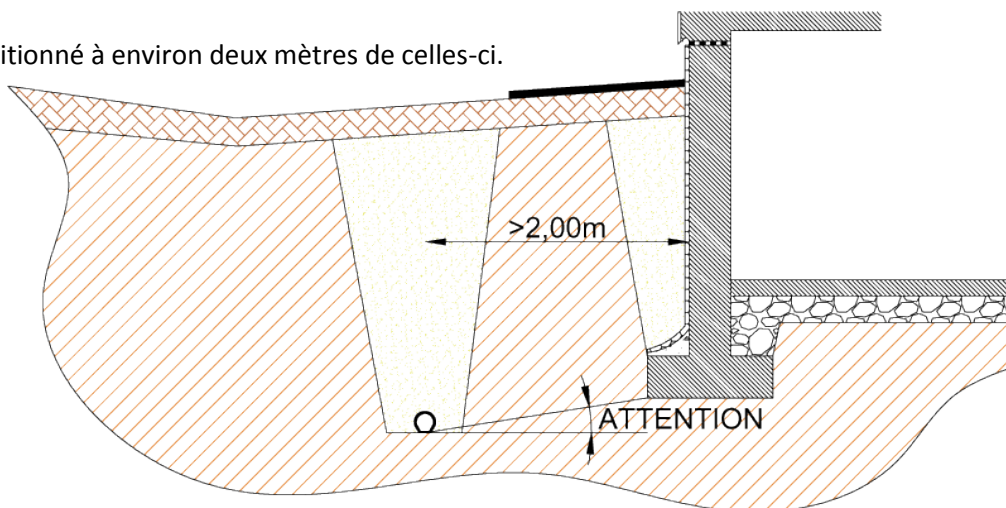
POSITIONNEMENT A DISTANCE DES FONDATIONS
